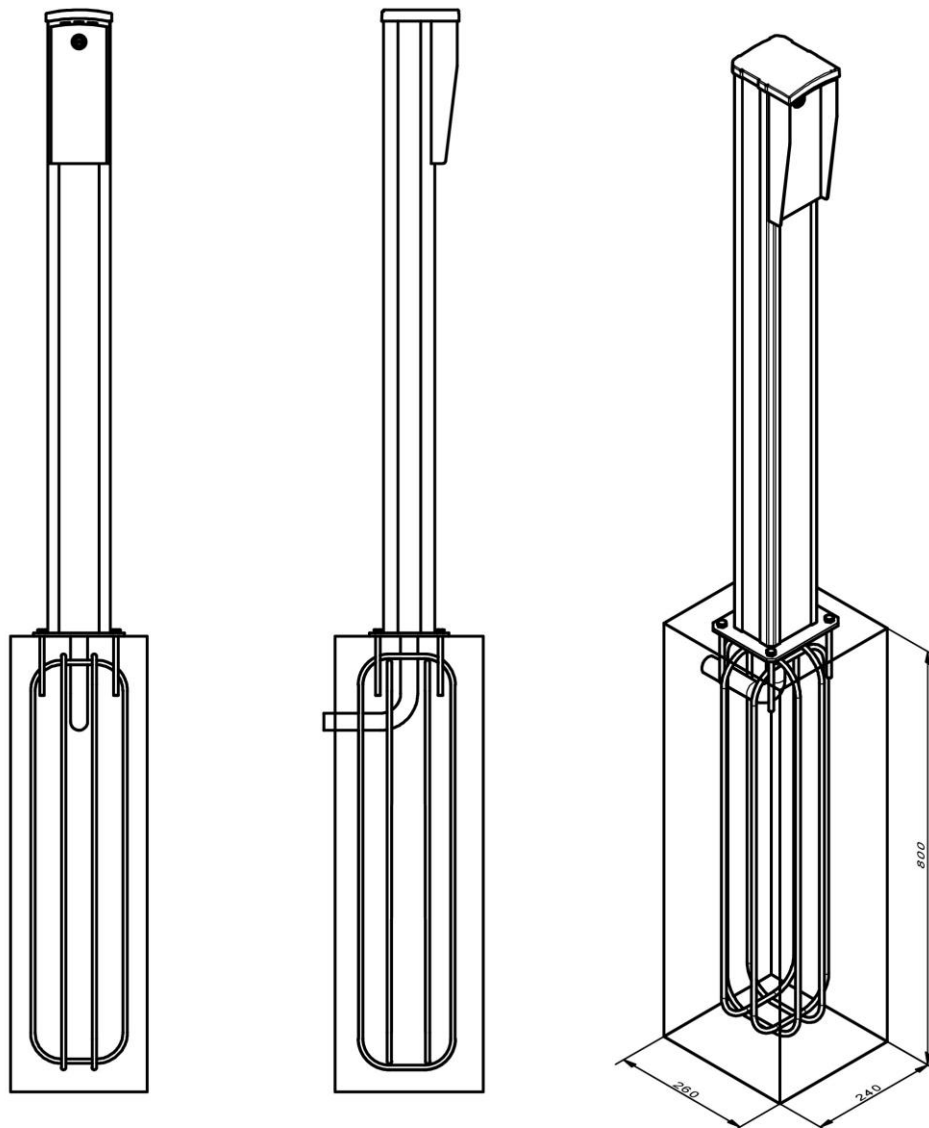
Aluminium-Säule LS und ST mit Fundament inkl. Bewehrung und Leerrohr
